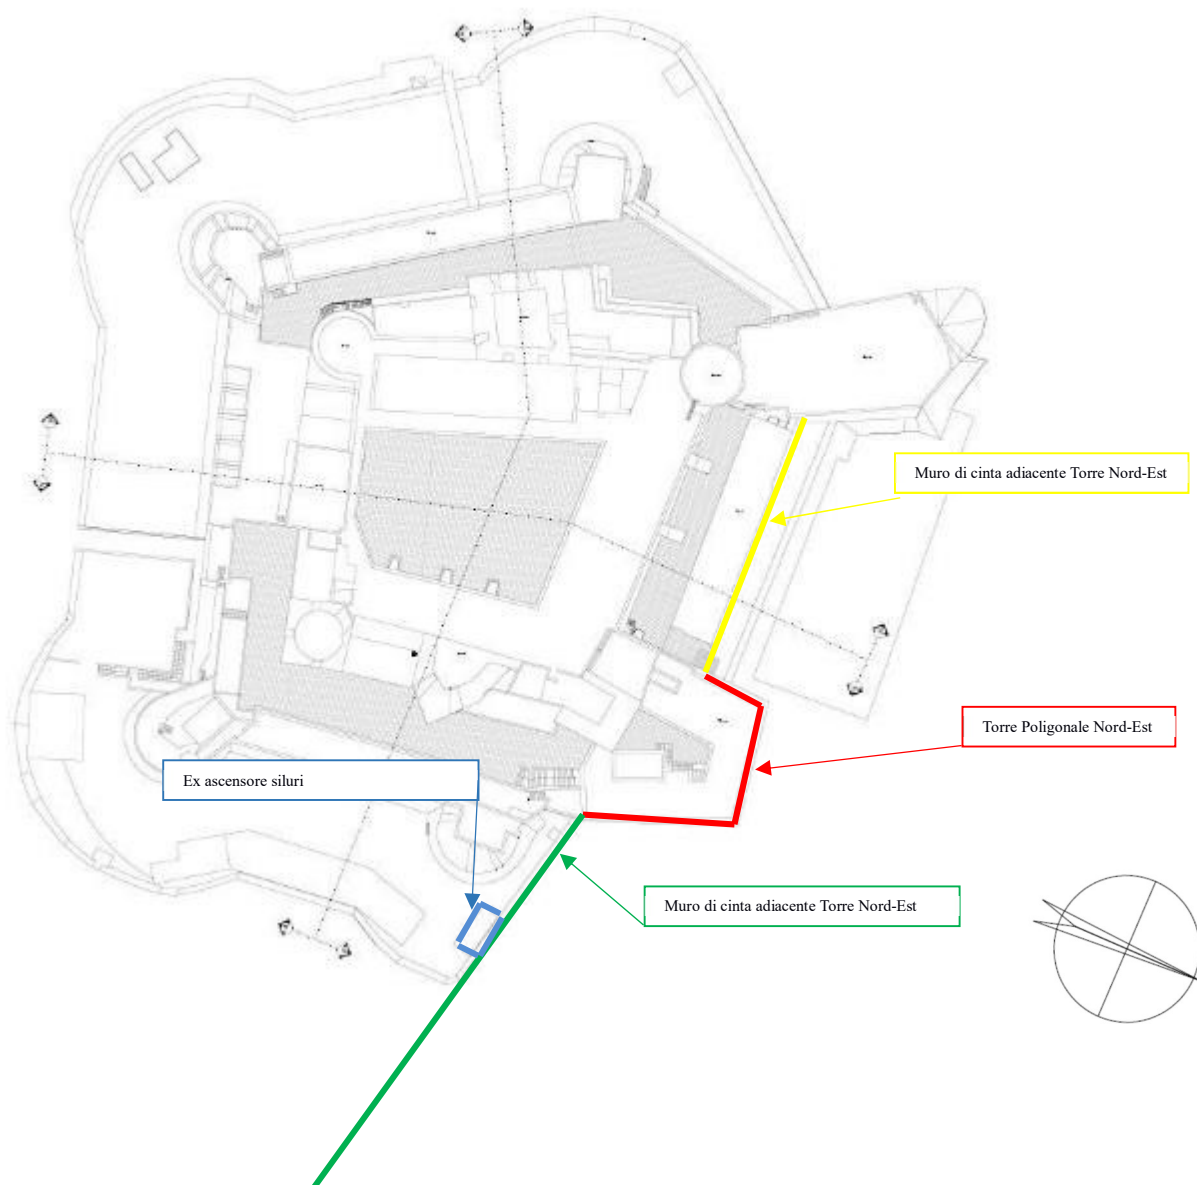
Pianta Castello Svevo di Brindisi con indicazione Torre Poligonale N-E e mura di cinta adiacenti
